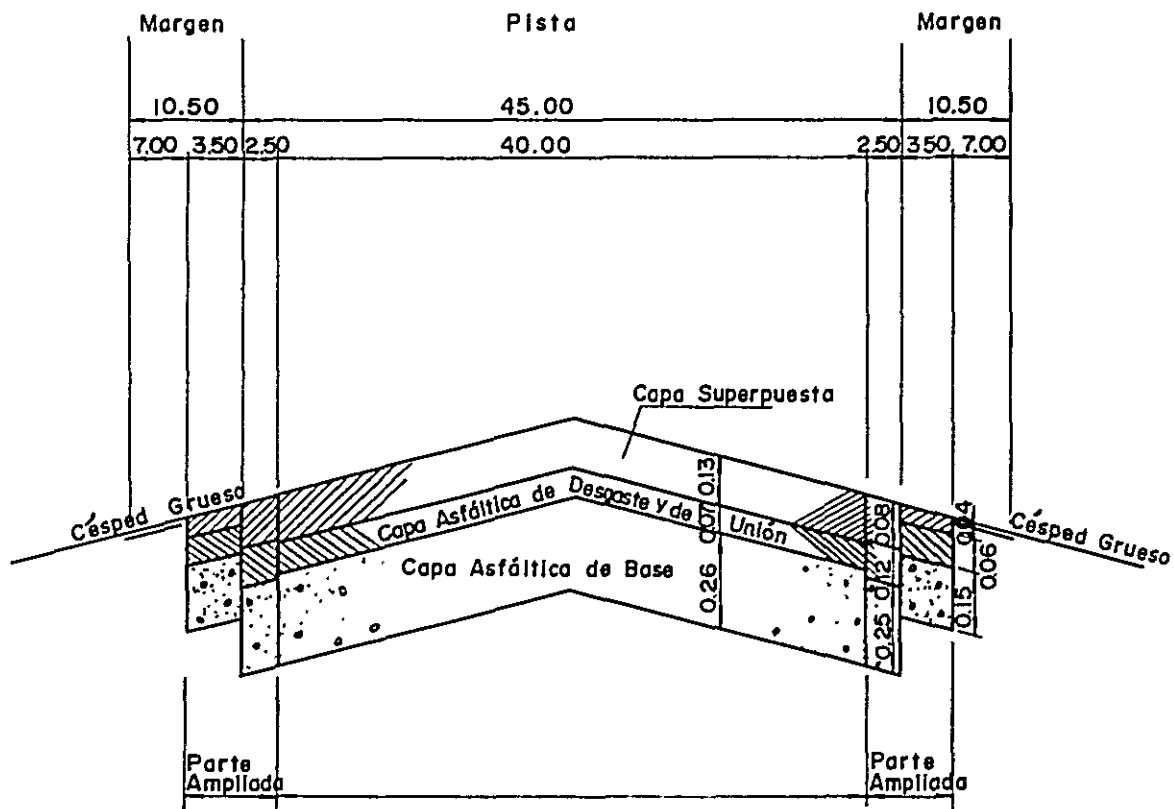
Sección Típica del Pavimento Flexible - Pista
